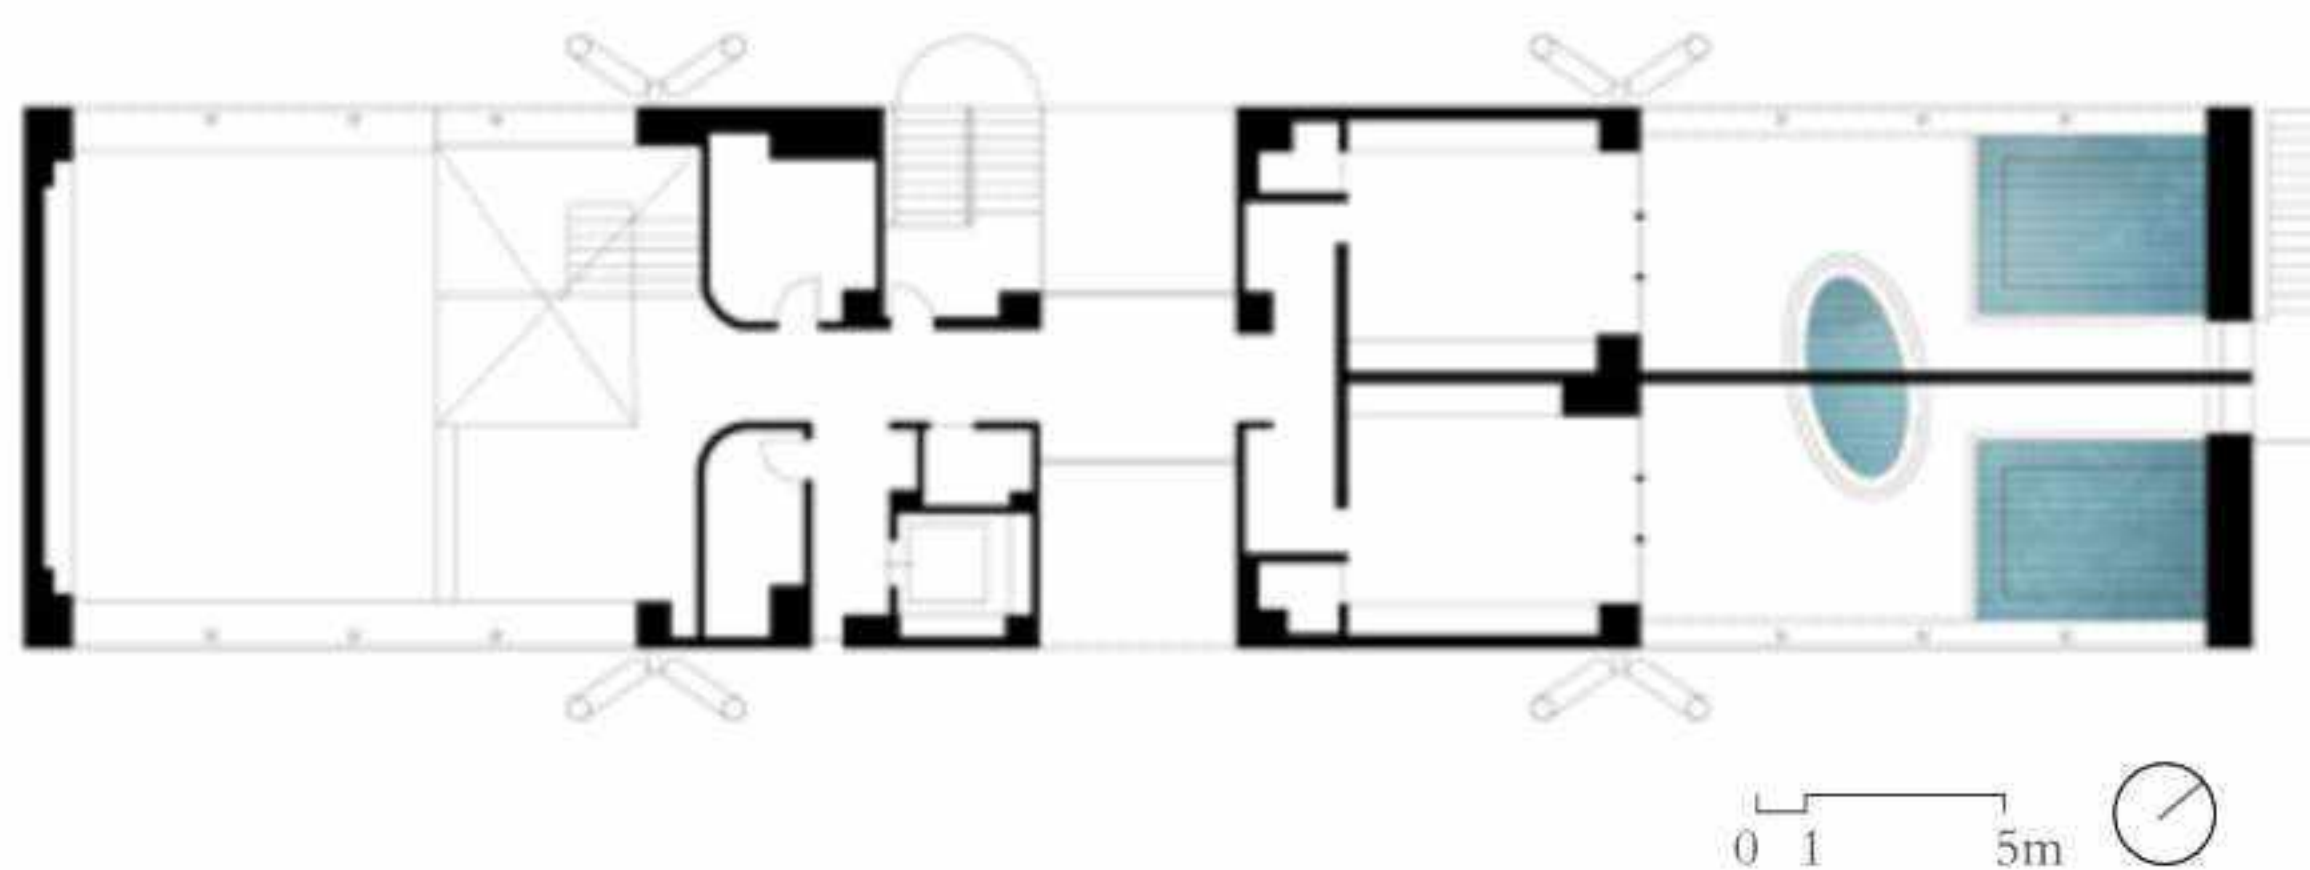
Bagni della stazione Onagawa*, pianta dei bagni, piano primo.
